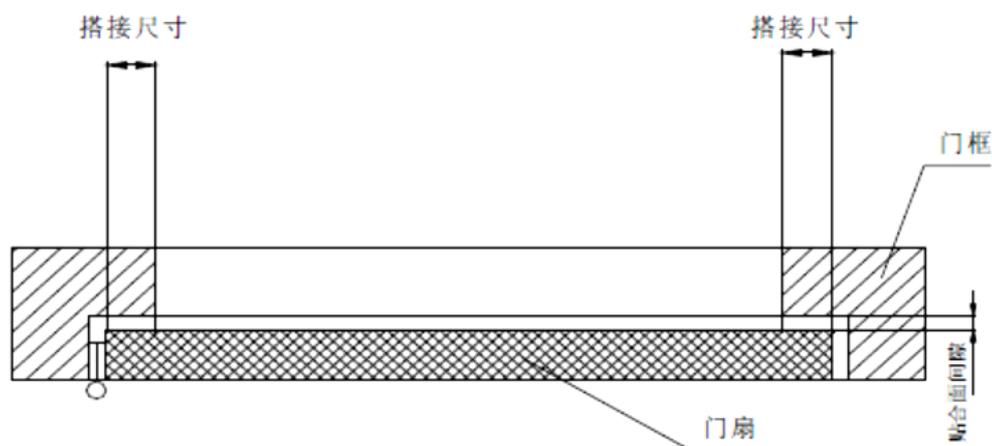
门扇与门框的搭接尺寸和贴合面间隙示意图
